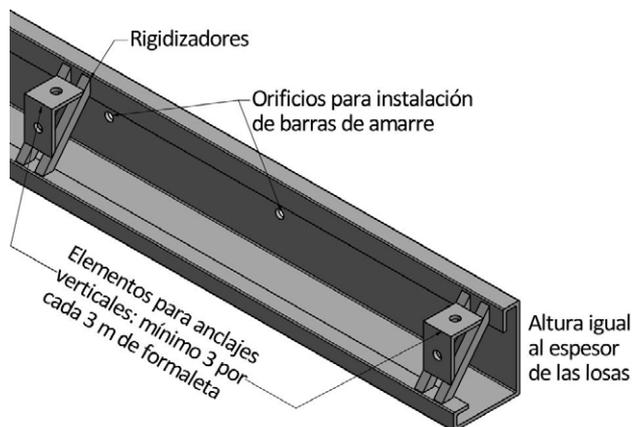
Esquema ejemplo de formaleta para pavimentos de concreto
